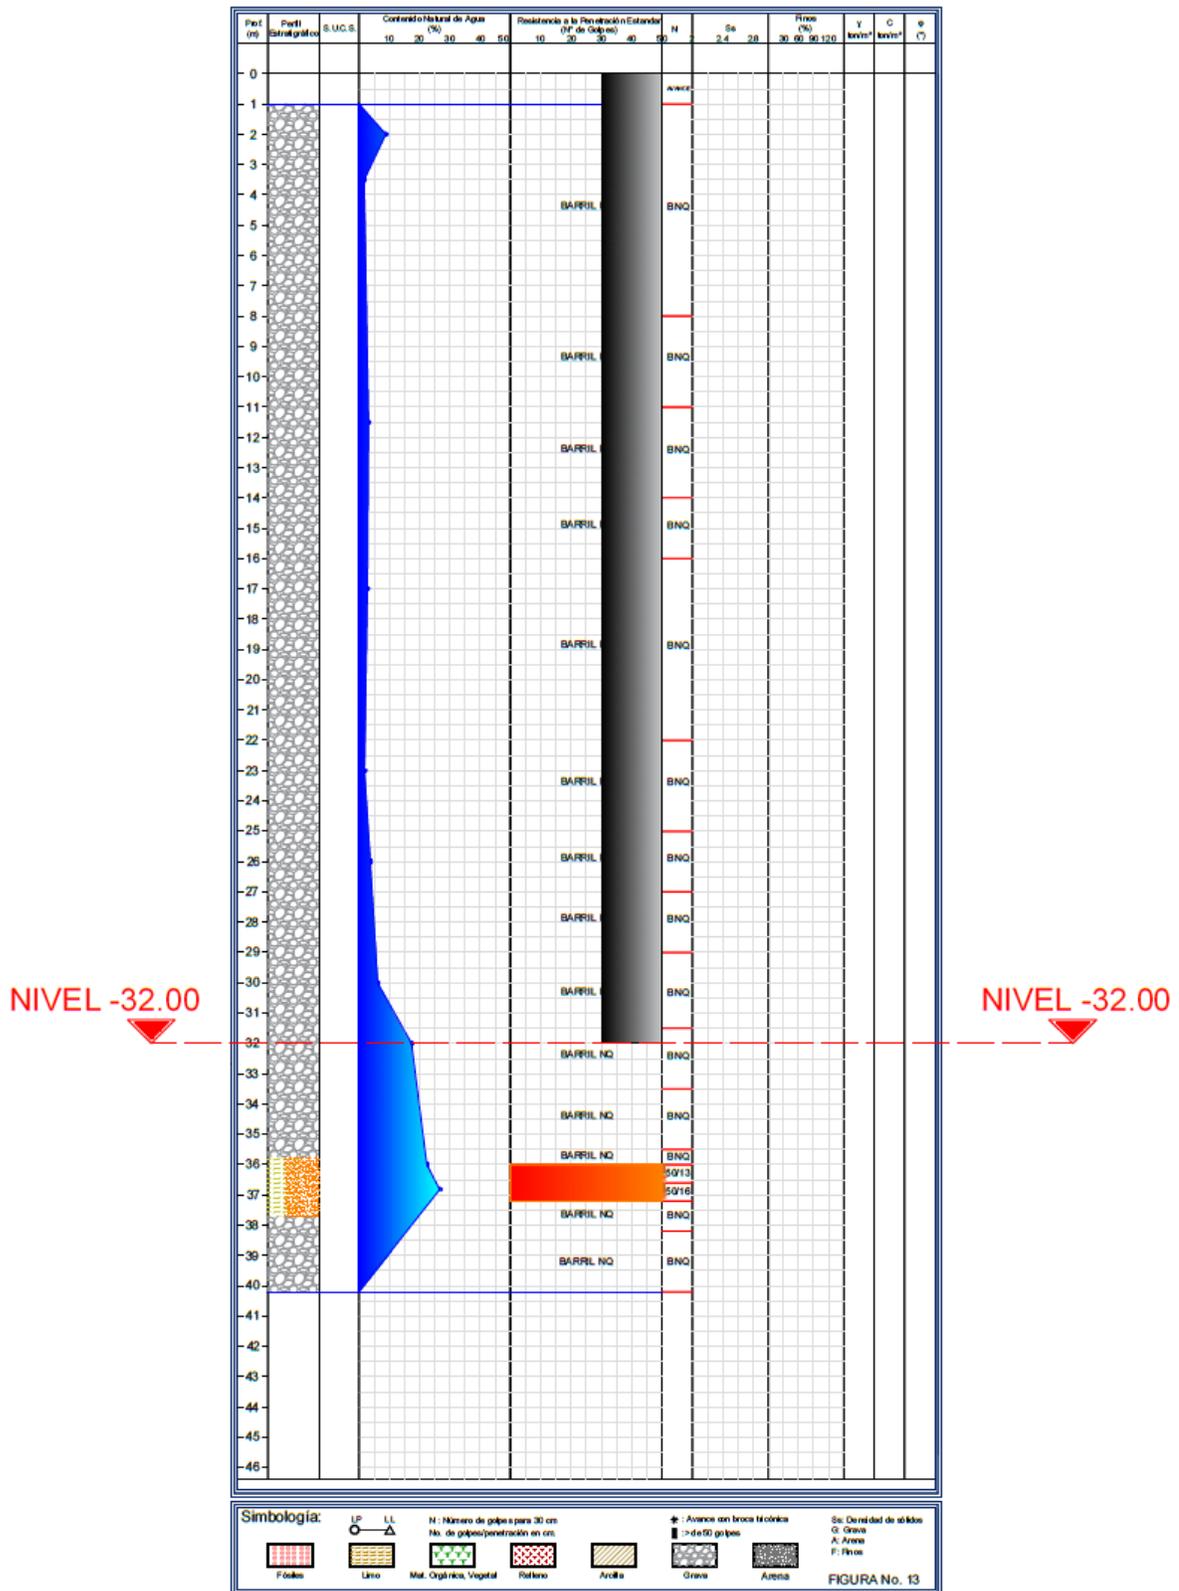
DESPLANTE DE PILA 4 (SM-4-EJE F7).
